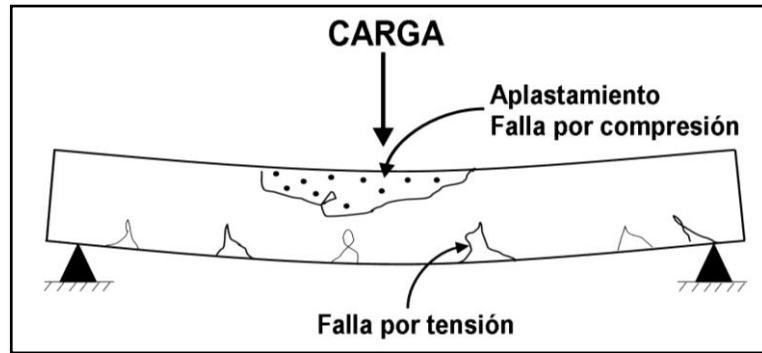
Fallas por Flexión en Vigas de Concreto Armado.
